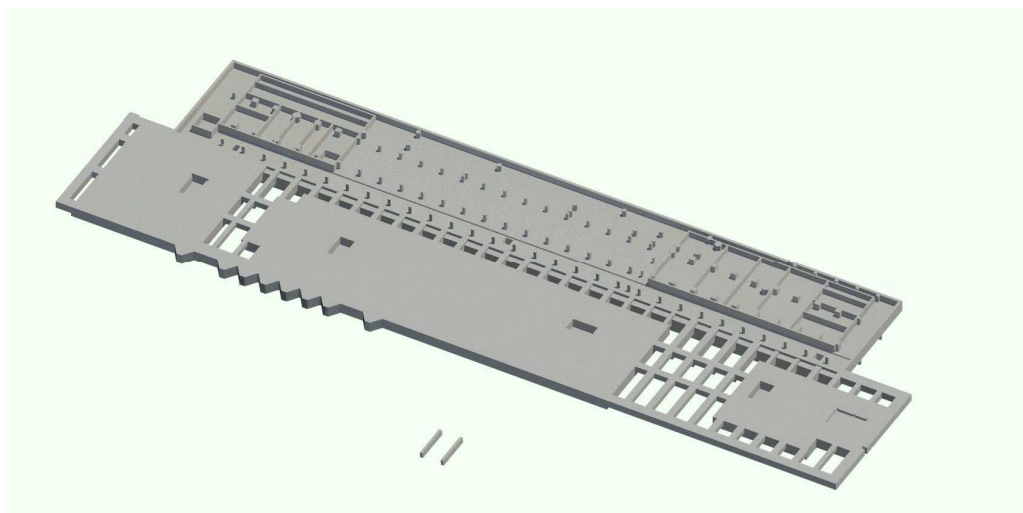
Pormenor de modelação das fundações e da cave do edifício.
